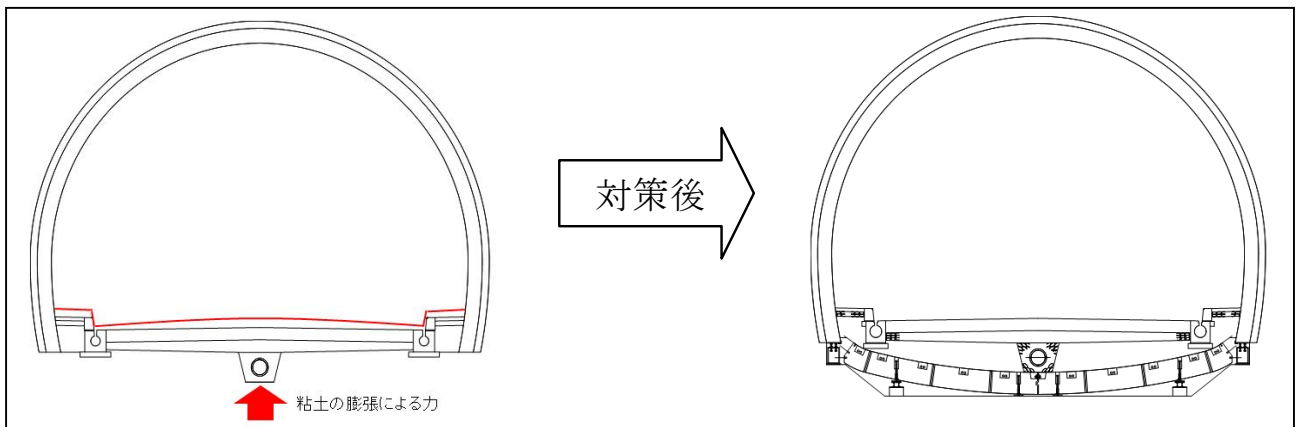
隆起箇所の現況トンネル断面図とイバート設置対策後断面図
